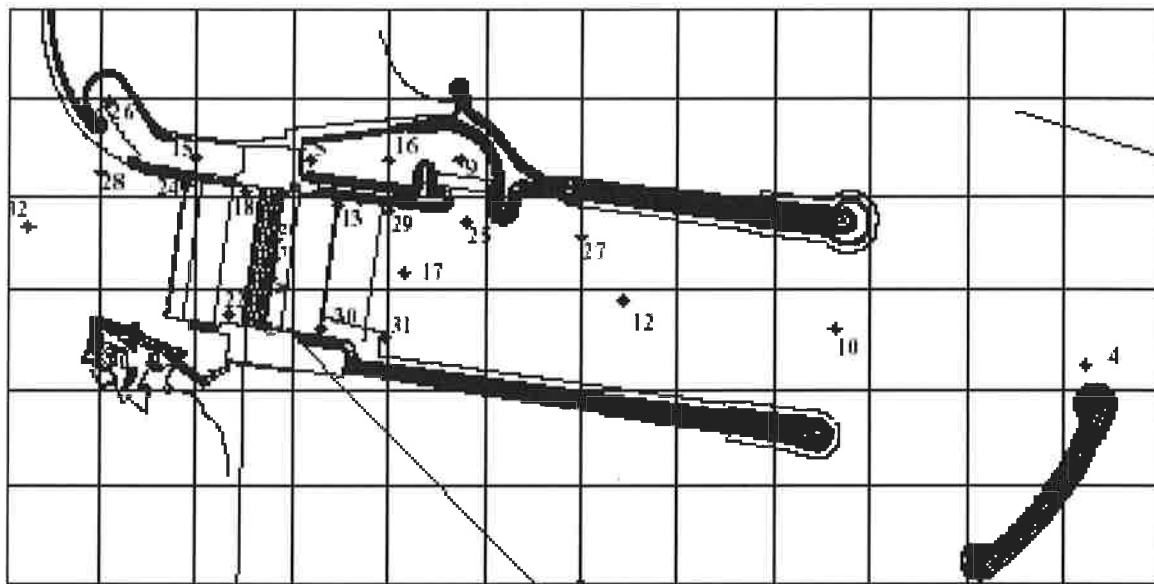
PLANIMETRIA MODELLO FISICO CON INDICAZIONE DELLE SONDE DI MISURA DEL MOTO ONDOSO (PROVE A PARATOIE ABBASSATE)
